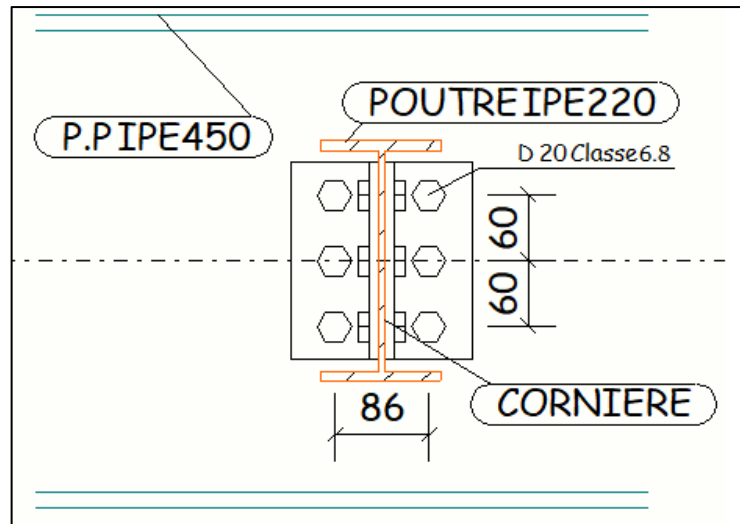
Disposition constructive des boulons. (Assemblage poutre-solive)
